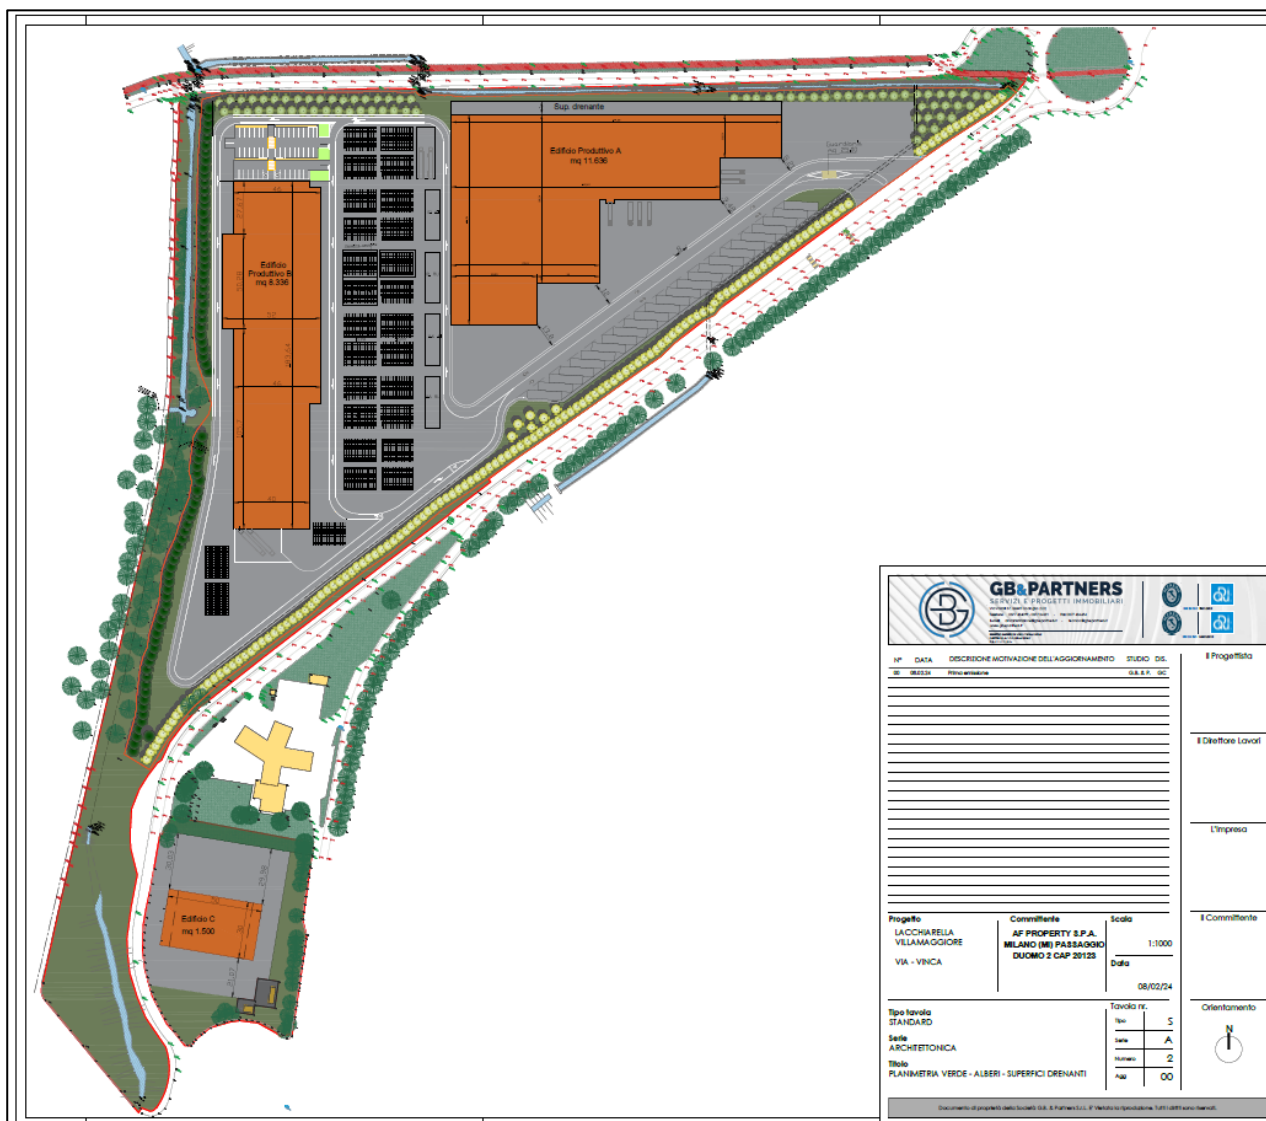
Layout planimetrica generale di progetto; (fonte: GB & Partners srl).
